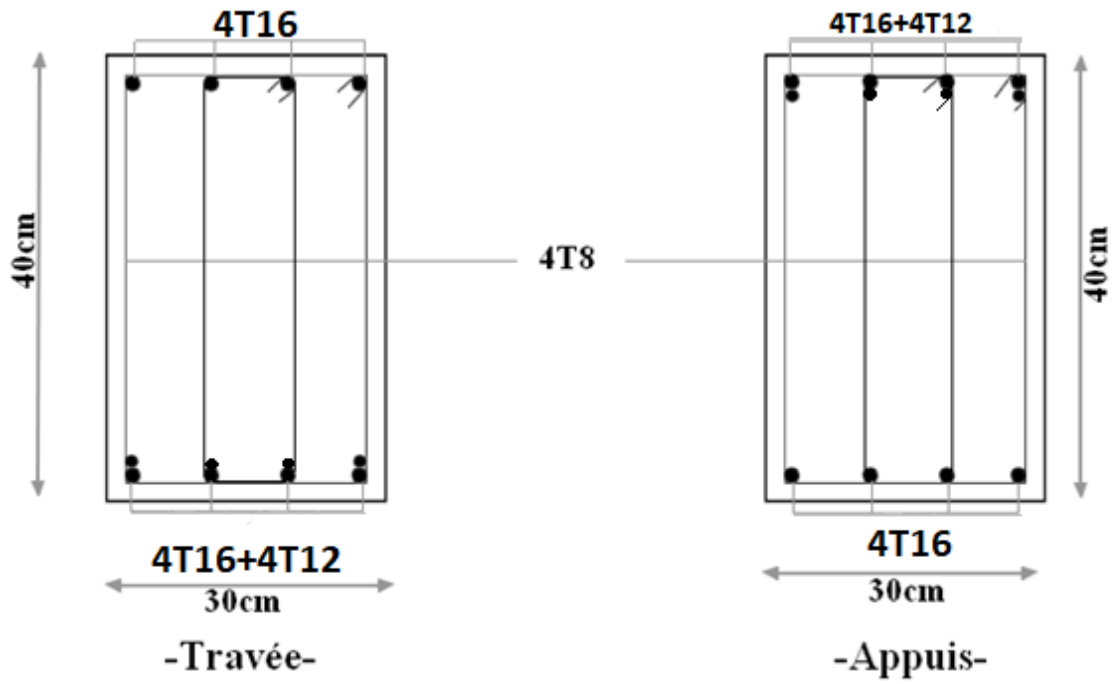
Schéma de ferrailage des poutres secondaire de la terrasse.
